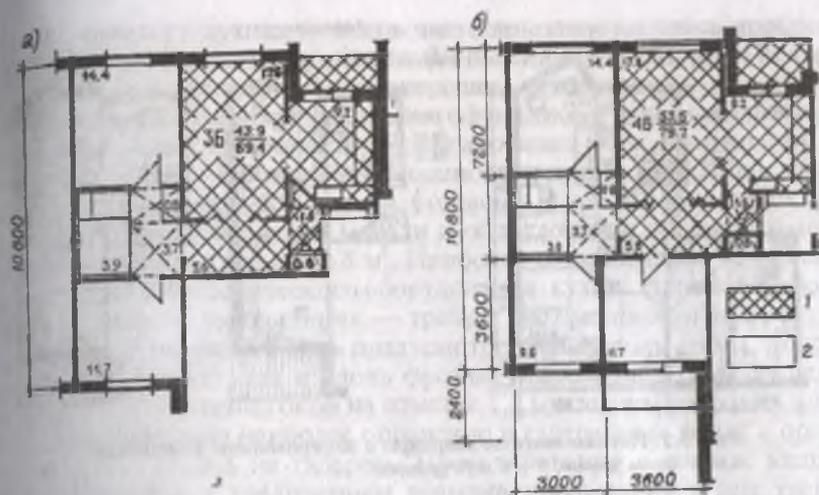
Функциональное зонирование помещений 3...4-комнатных квартир:
